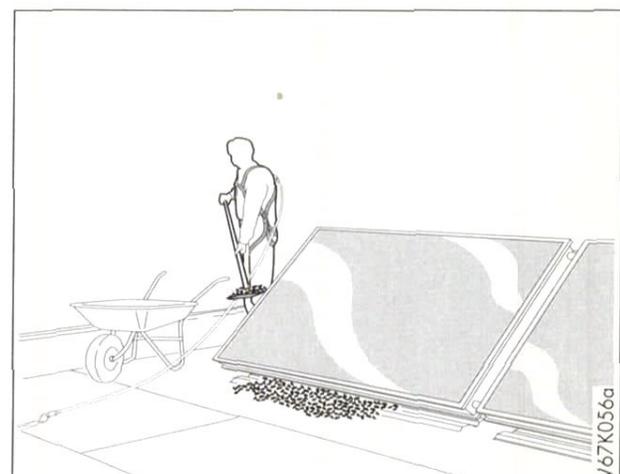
Zum Abschluß Kiesplatte mit einer Kiesschicht von mindestens 10 cm überdecken (über 8 m Gebäudehöhe mindestens 15 cm).
